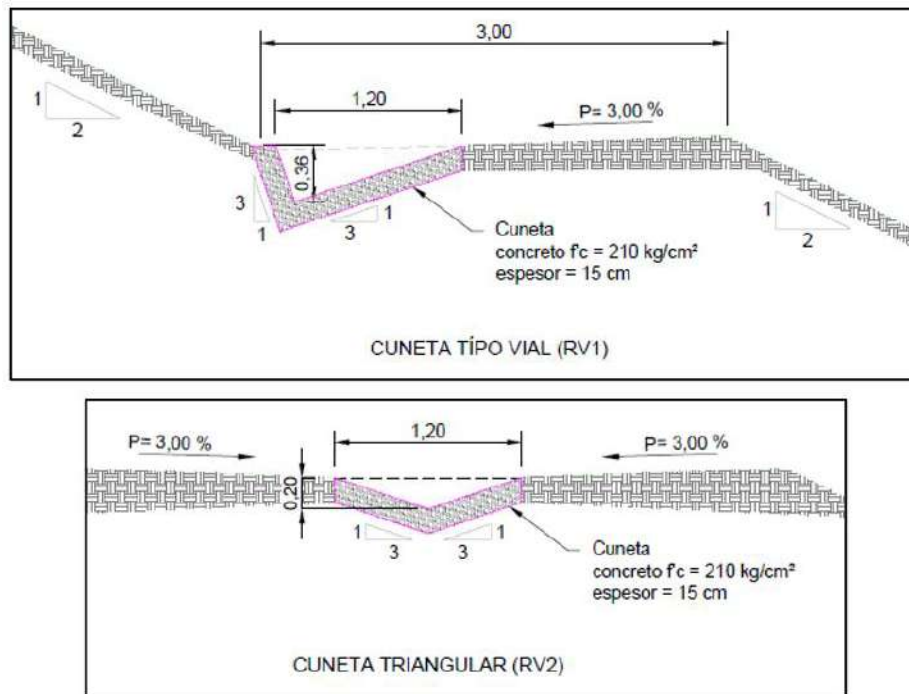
Esquema cunetas en concreto (sección transversal)
